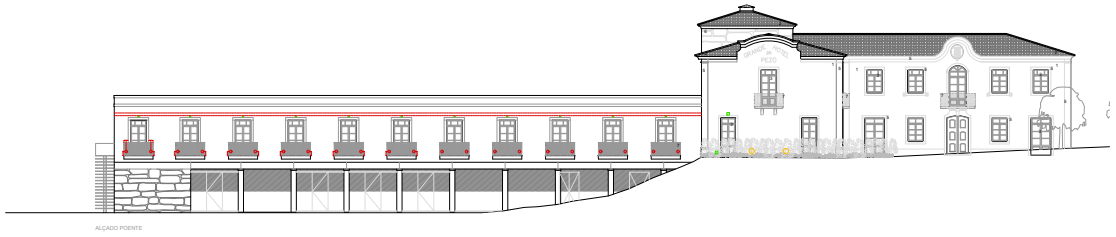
Alzado poniente de la intervención (2022). Fuente: Queiras & Xedas Construções.
